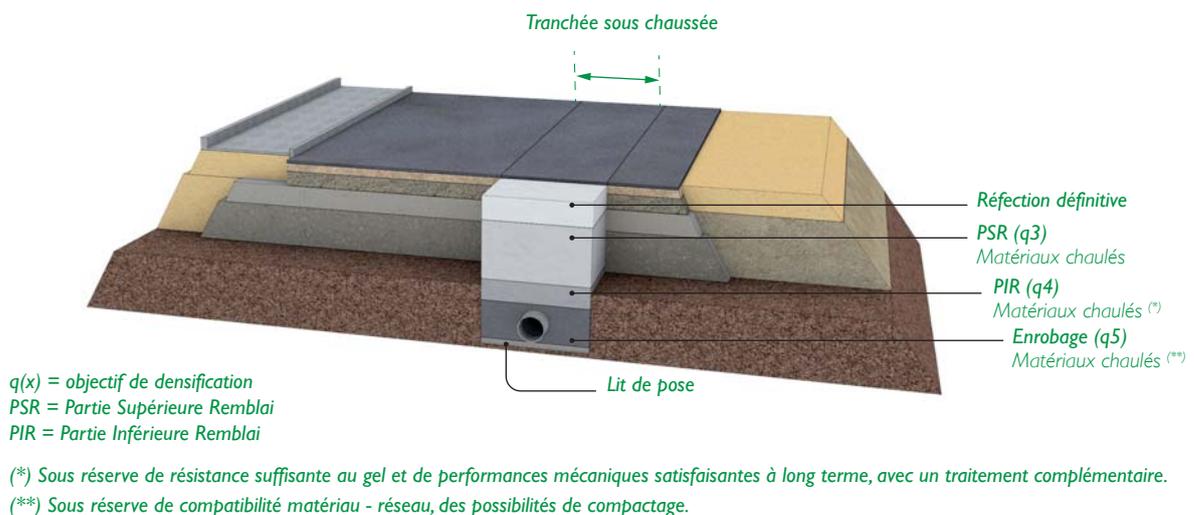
Usages possibles des matériaux chaulés en remblayage de tranchées ou travaux de canalisation
